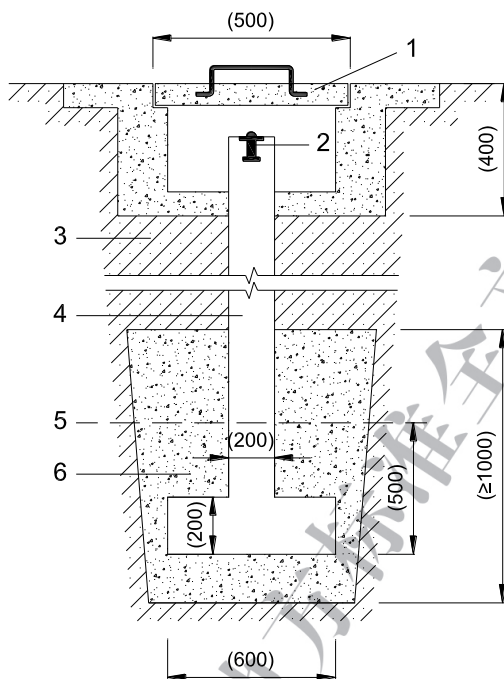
混凝土平面基准点标石埋设（单位：mm）
